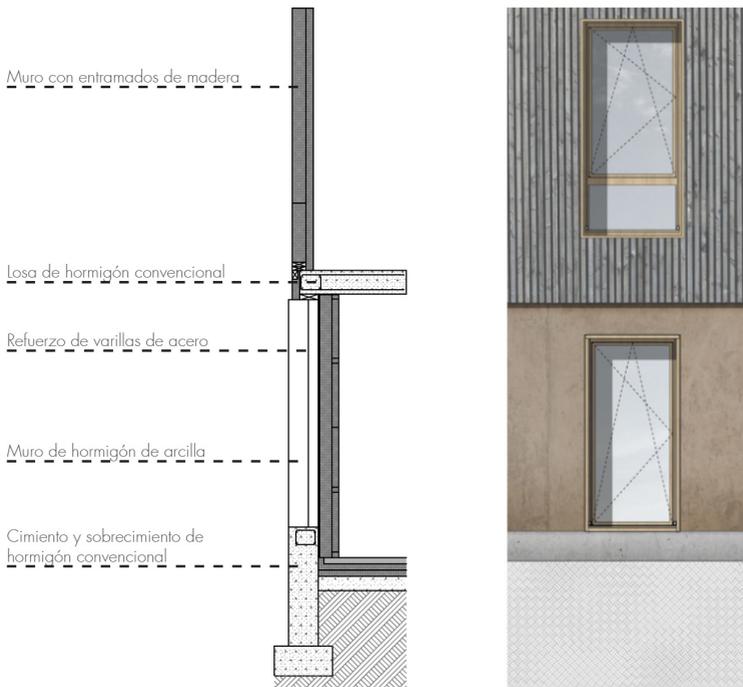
| Detalle de tabique de hormigón de arcilla construido en 2028 para el proyecto Pépinière d'entreprises à Saint-Clair-de-la-Tour, Isère, Reach & Scha. | Fuente: Autoría Propia (2024).
